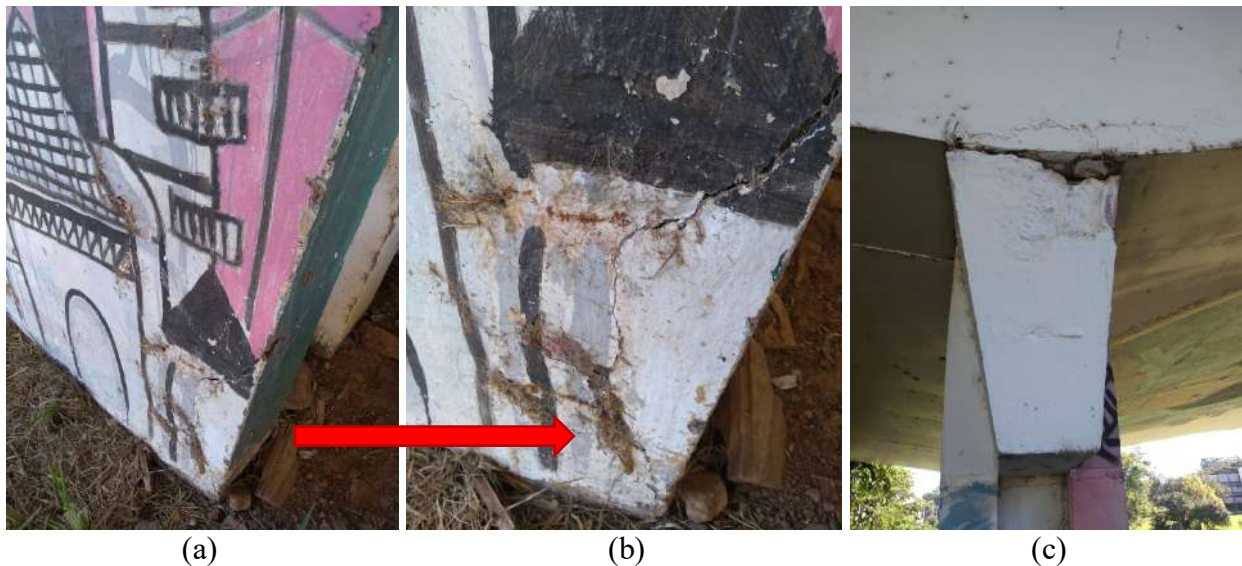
Desplacamento na base de pilar (a); detalhe do deslocamento (b); deslocamento com exposição da armadura em viga travessa (c).
